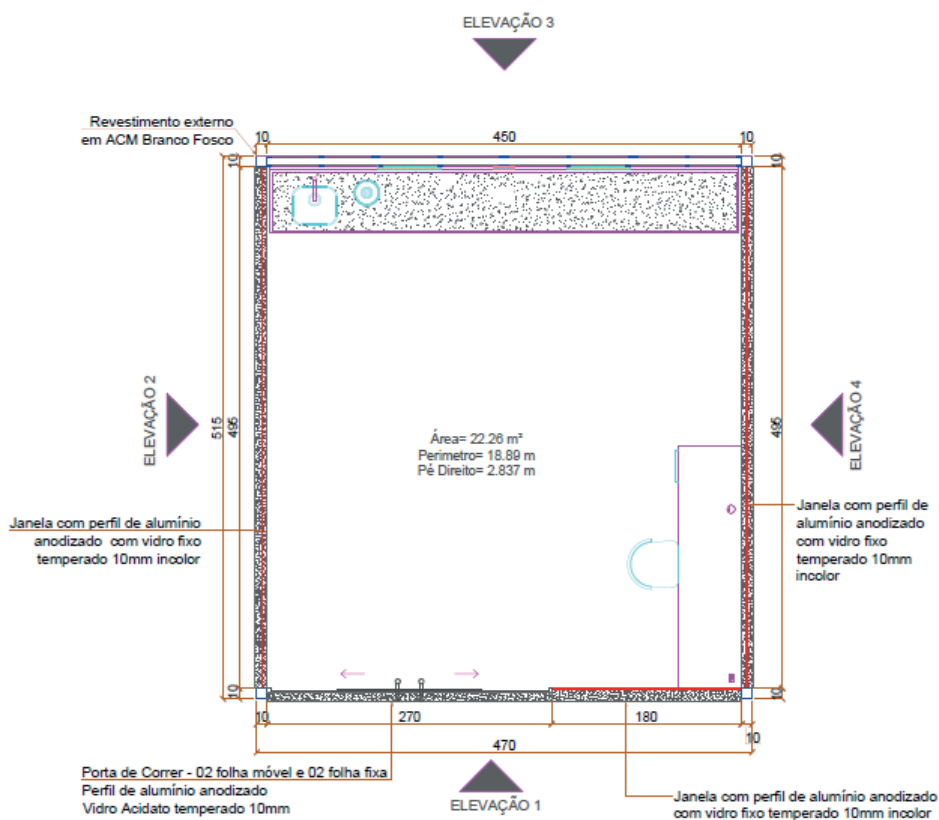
Planta baixa do projeto modular em estudo com indicação das elevações e cotas em centímetros
